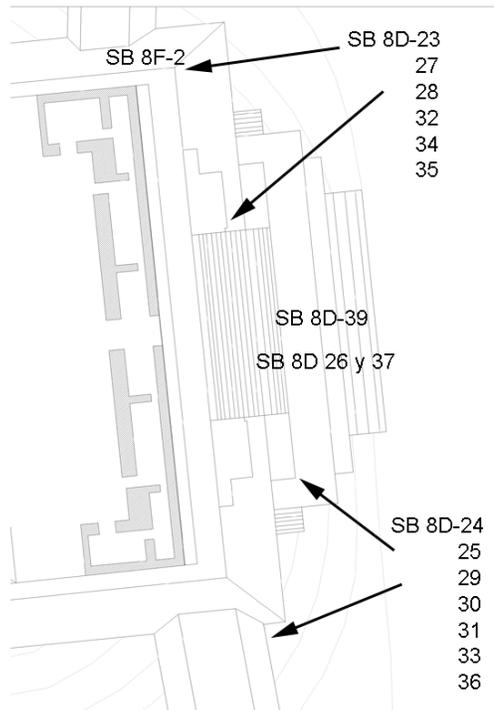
Planta de la fachada de Tigrillo con ubicación de unidades.
